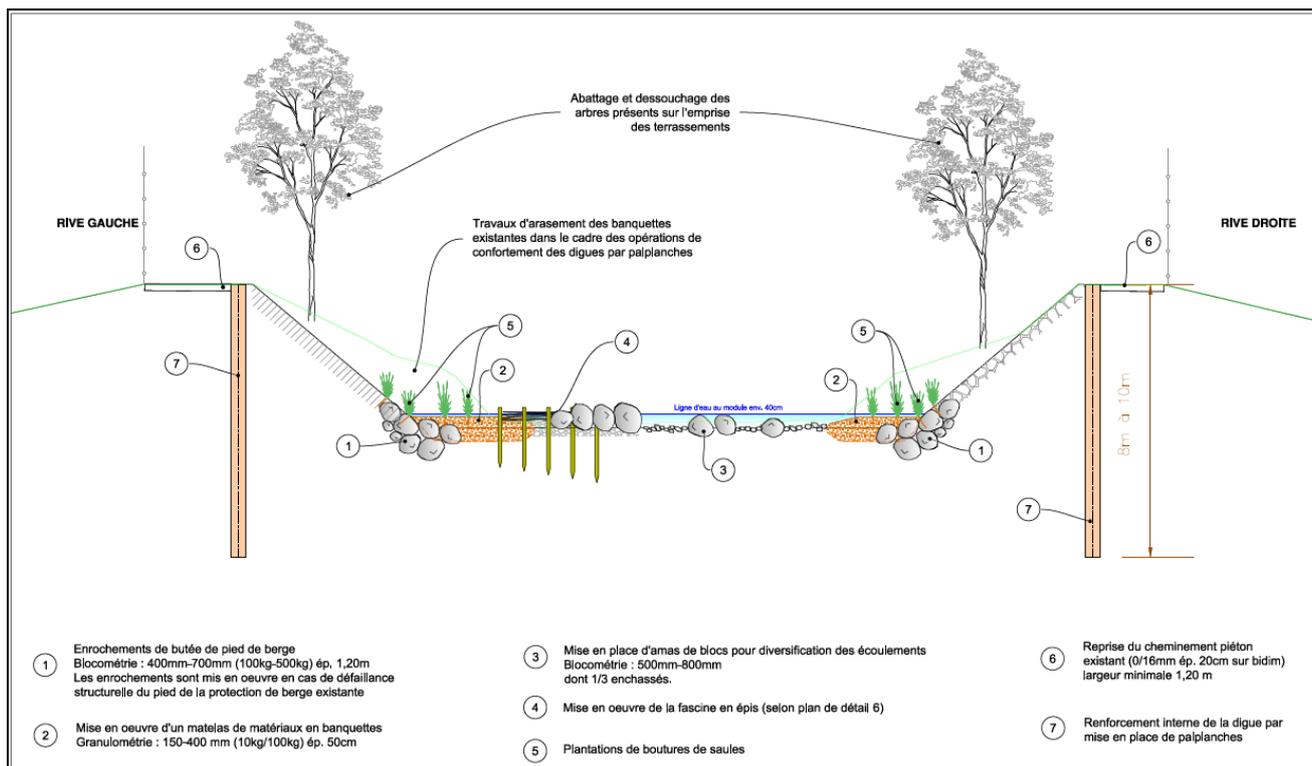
Coupe type 2: palplanches ne dépassant pas de la digue (Source: PRO Safège, avril 2018)
